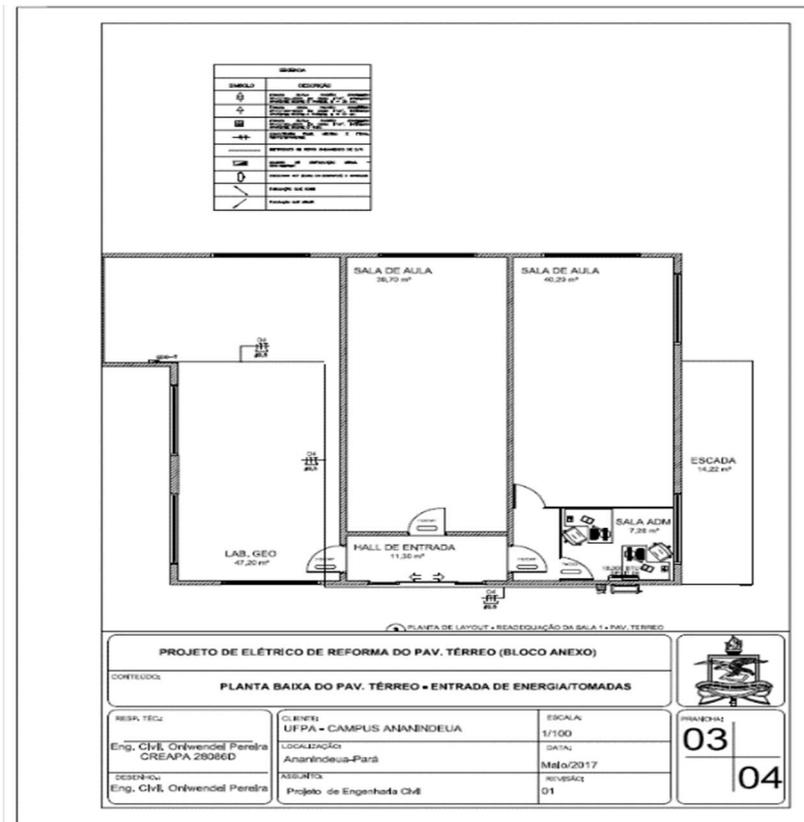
Projeto elétrico/Climatização do pavimento térreo, no bloco anexo.
